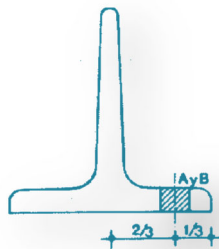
Perfil en T. Fuente: Diseño de Estructuras de Acero de McCormac
